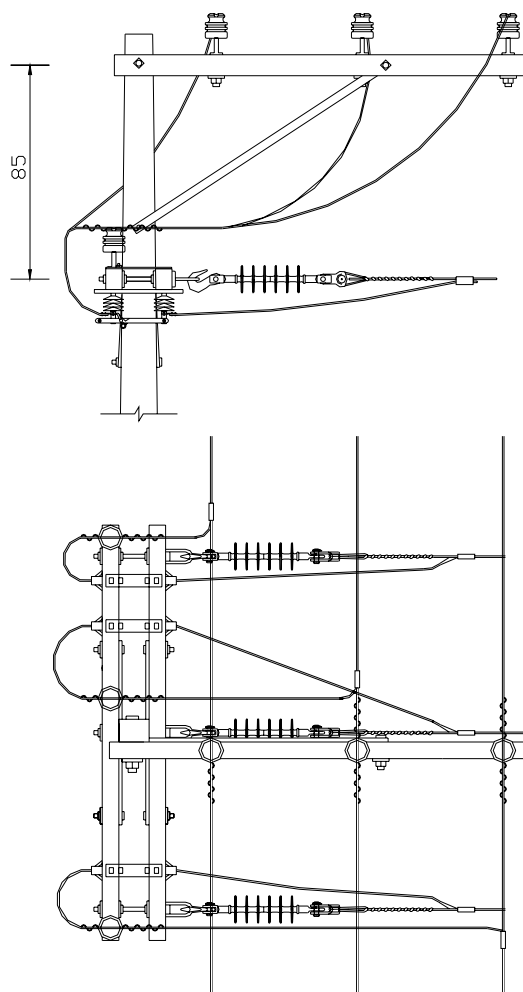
Estrutura B1-N3 (derivação chave faca)
